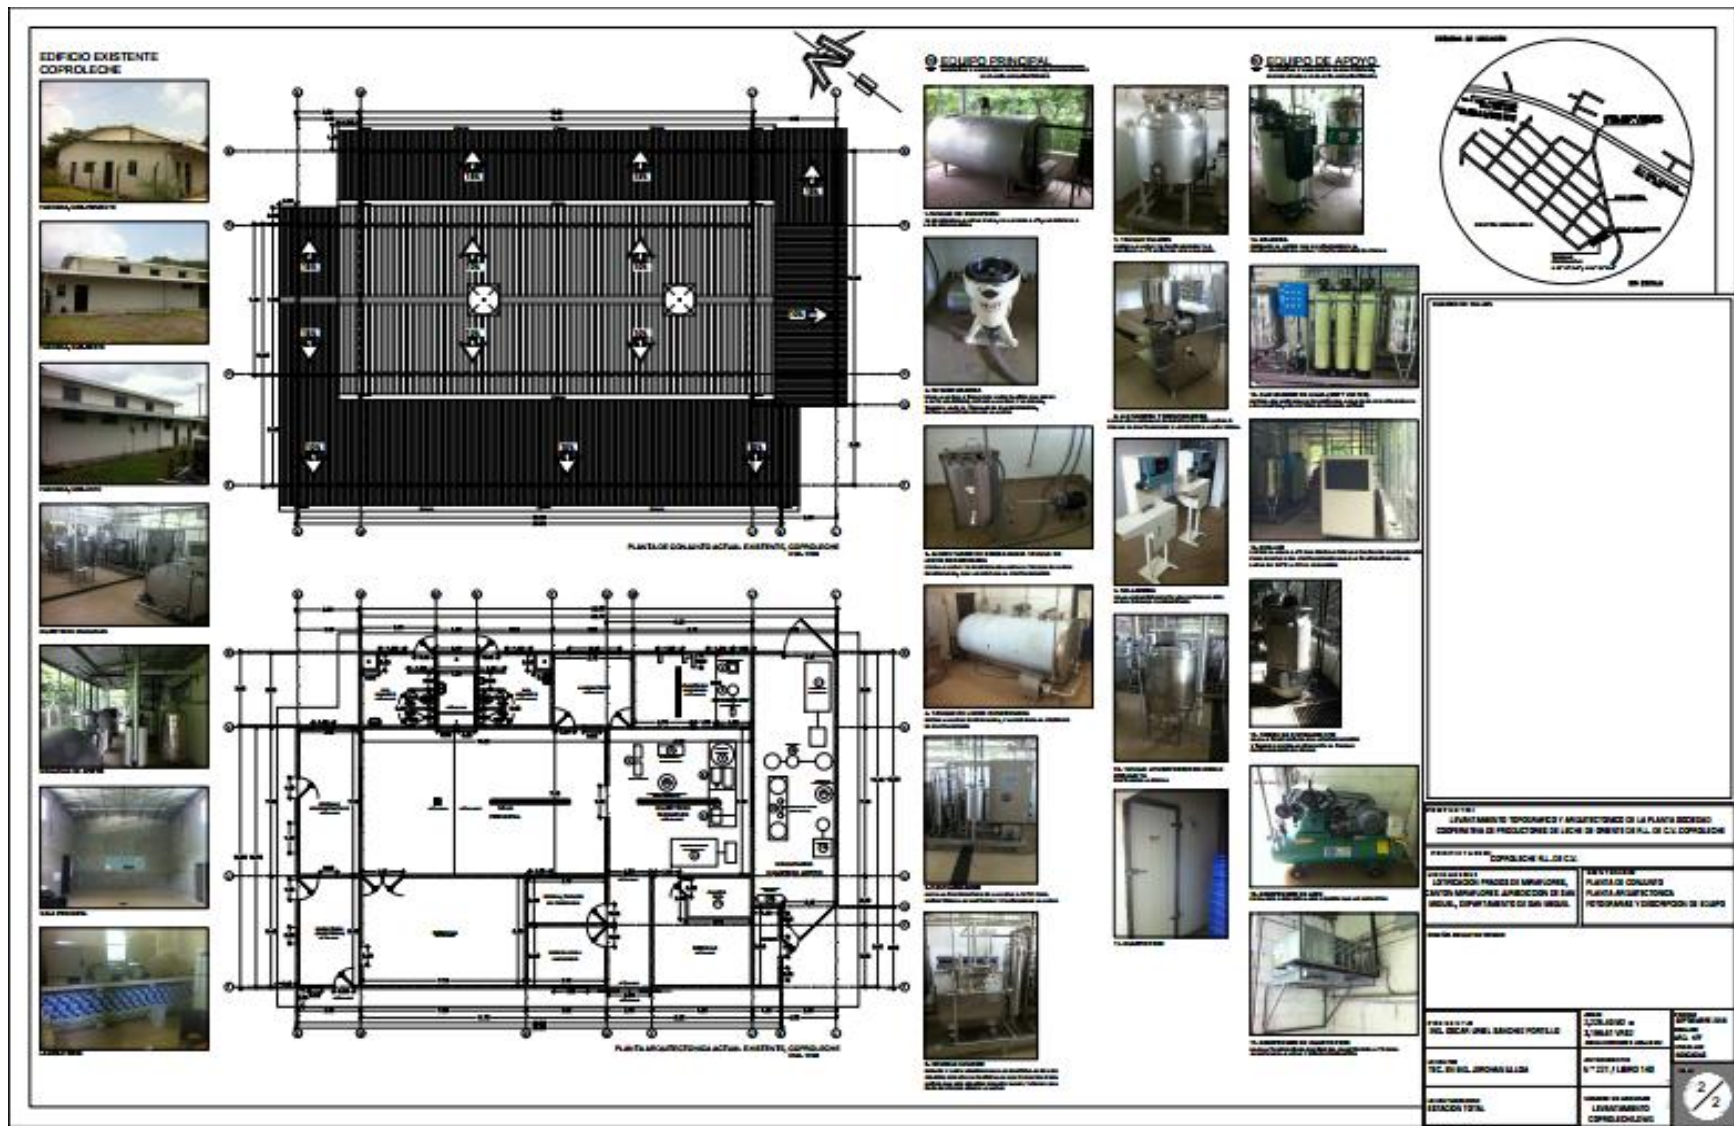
Levantamiento topográfico y arquitectónico de la planta COPROLECHE, en donde se muestra el conjunto de la planta, la planta arquitectónica y fotografías y descripción de todo el equipo.
